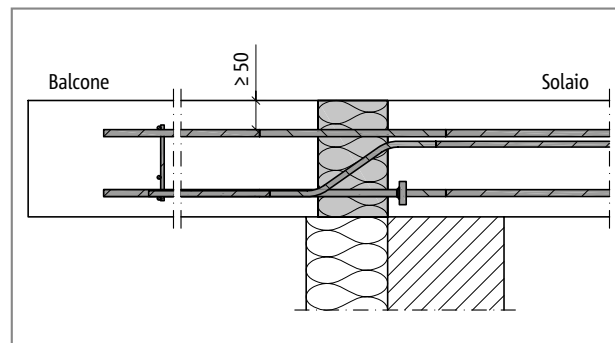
Schöck Isokorb® tipo EXT-CV50: raccordo con sistema di isolamento a cappotto (WDVS)
